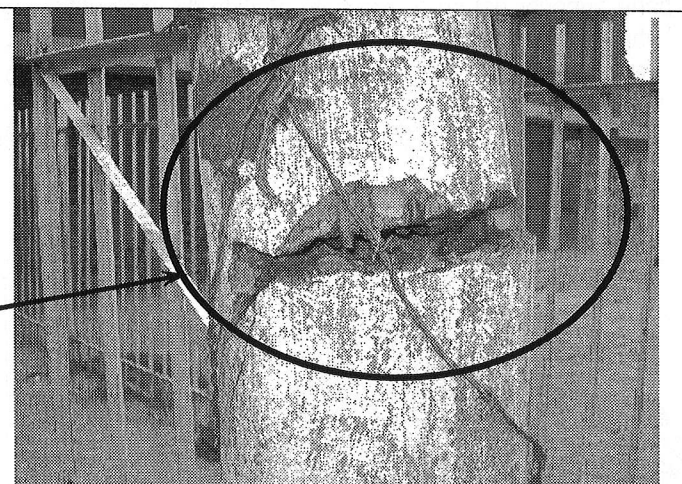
Vista de la fractura presentada en el poste de telefonía en concreto el cual evidencia la perdida de capacidad estructural del elemento.
